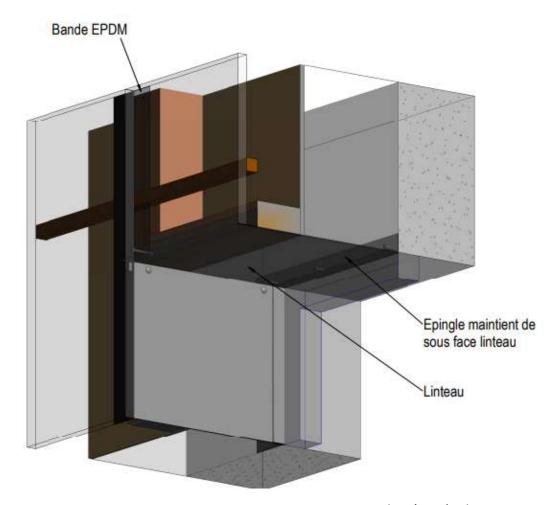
Vue 3D en coupe – Linteau avec chevêtre à plat
